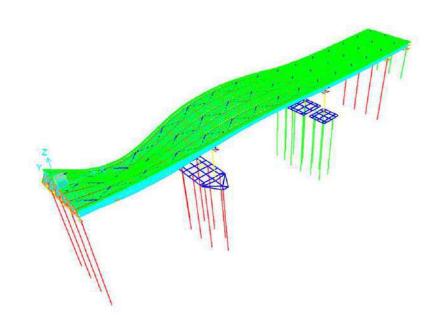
Deformada por efecto de la carga, Prueba 1 – 1Camión (P1C1).
